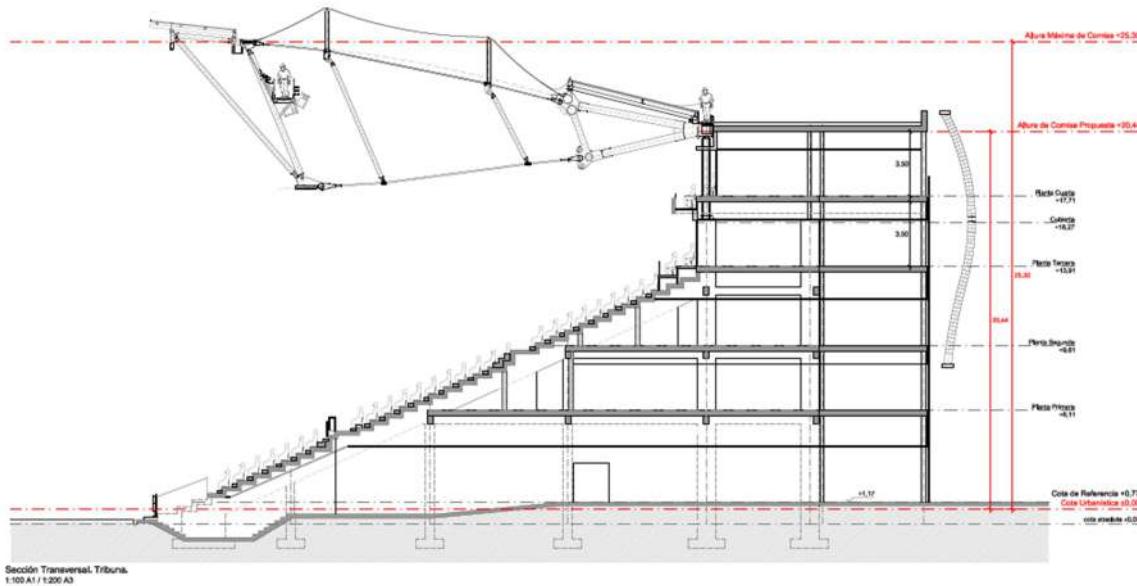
Secciones Estado Modificado – Sección Transversal
